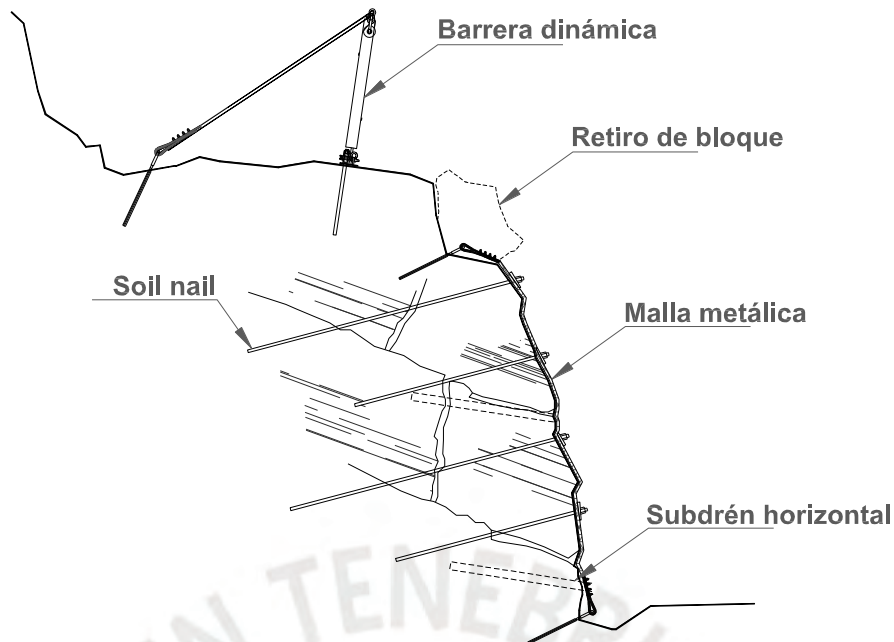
Elementos estructurales para la estabilización y mitigación de riesgo.
